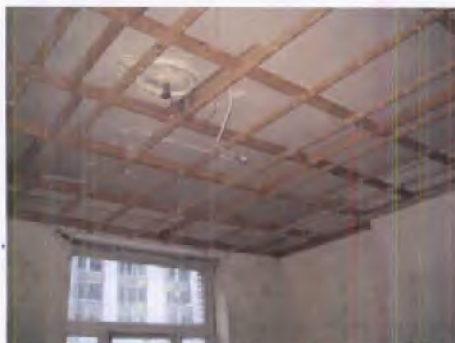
Slaapkamer straatkant (J. Candon, 2007).
